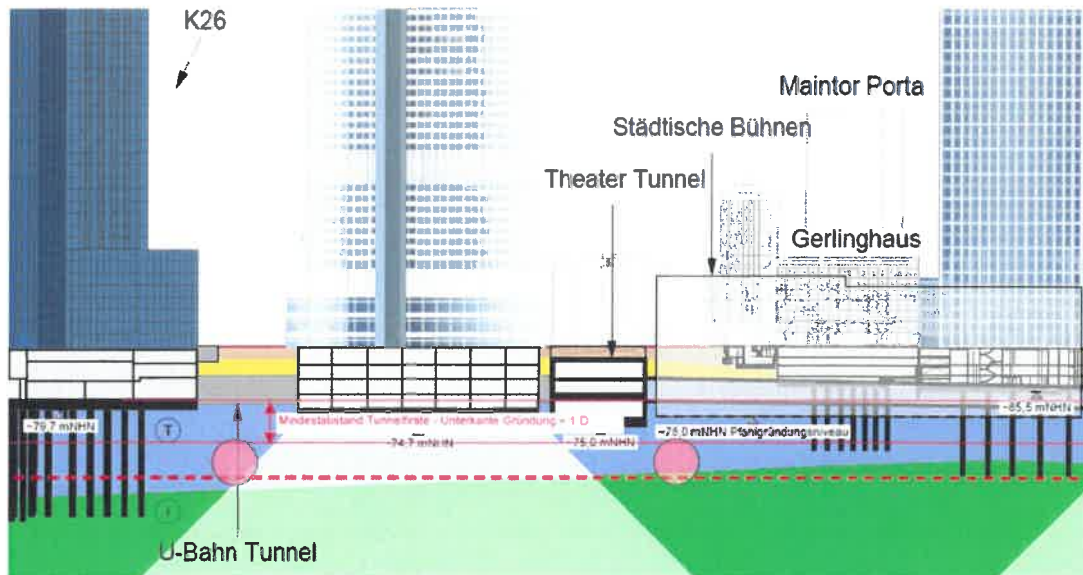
Auszug aus Plan „Baugrundschnitt (S I) durch die Wallanlagen (schematische Darstellung) inkl. Lastausbreitung der bestehenden Flachgründung“ mit Mindestabstand $1 \times D$
